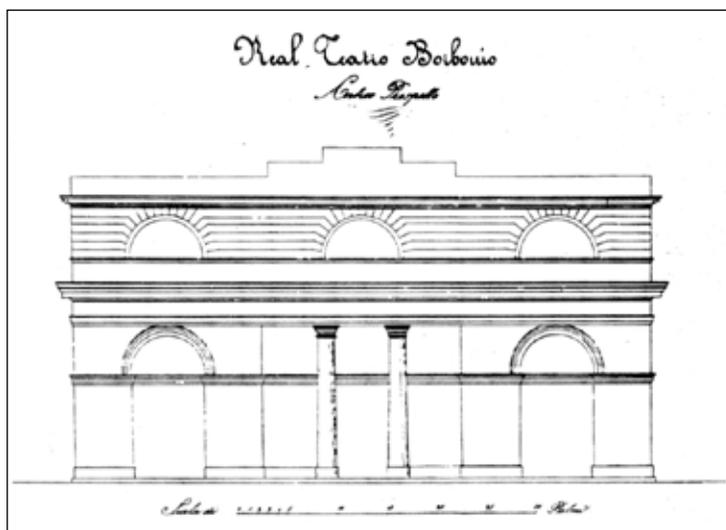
Disegno dell'antico prospetto del Real Teatro Borbonio (Reggio Calabria, Archivio di Stato)
